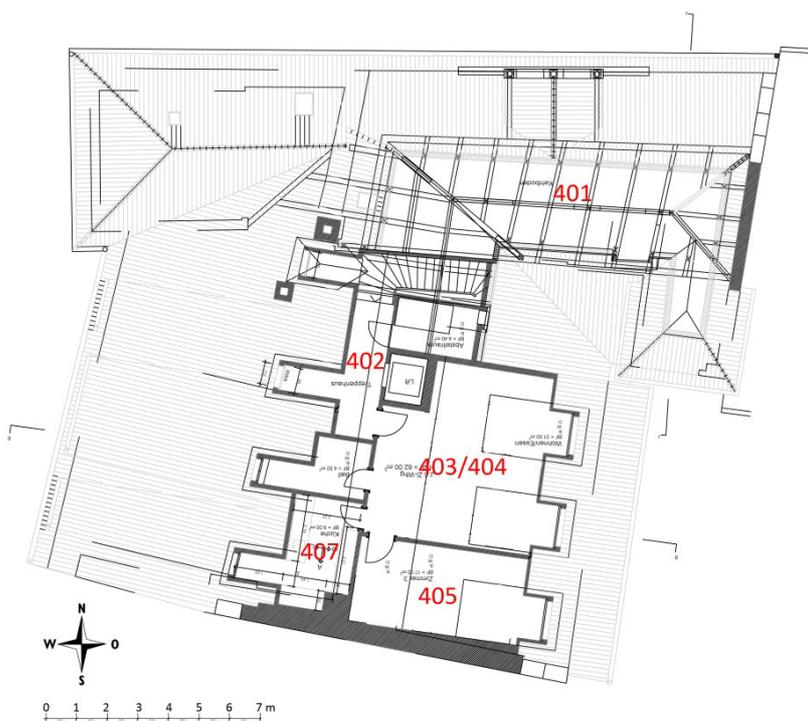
Korporationsgebäude. Grundriss 2. Dachgeschoss (Nordhaus) und 1. Dachgeschoss (Südhaus). Plangrundlage: Projektplan, März 2017.
